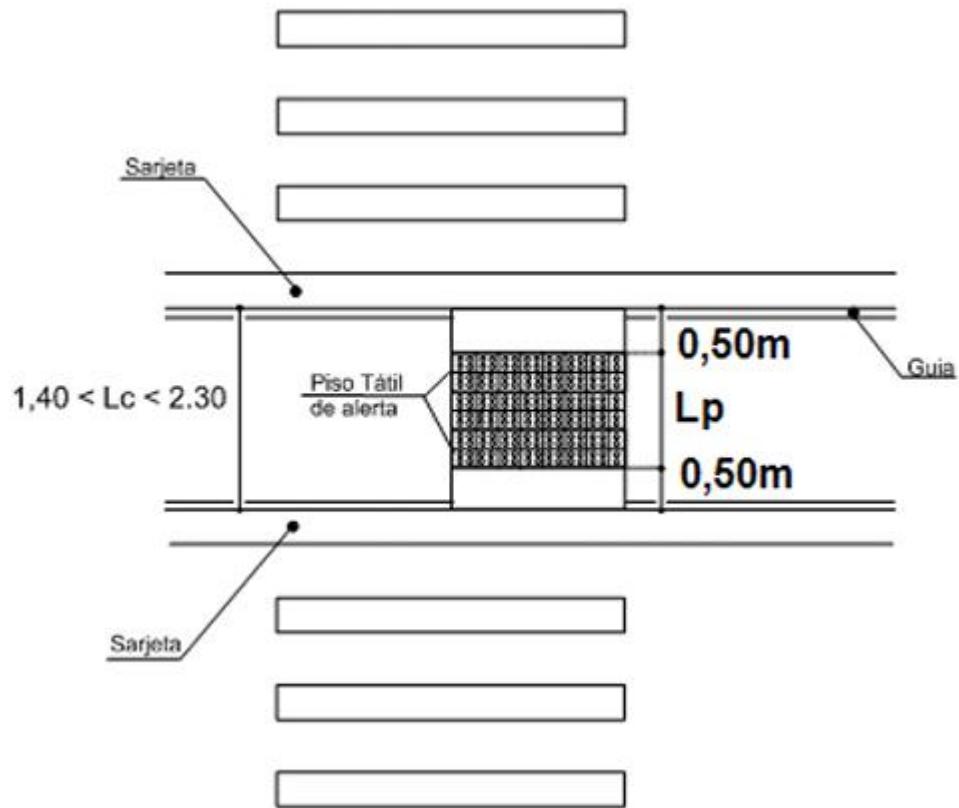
Planta - Rebaixamento em canteiro central entre 1,40m e 2,30m.
